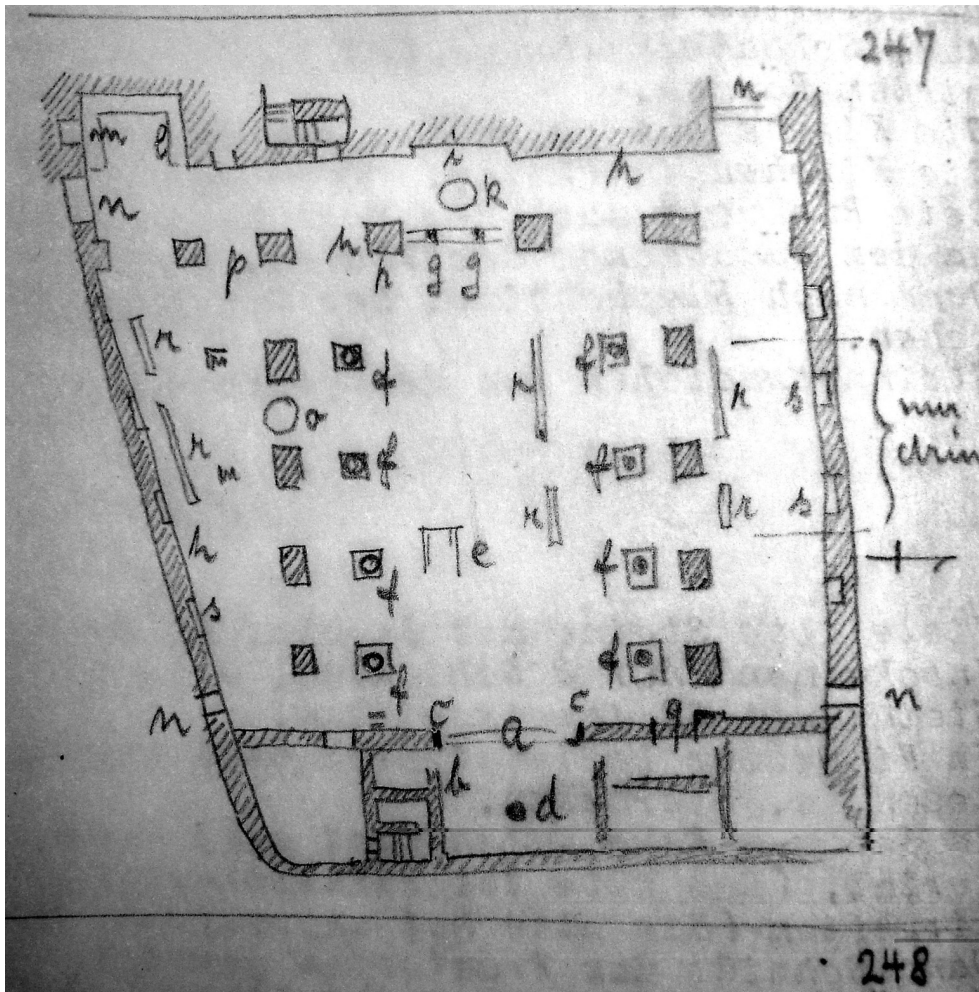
Grundrisssskizze der Kirche (aus dem Tagebuch 1895–1890 von L. BORCHARDT)
